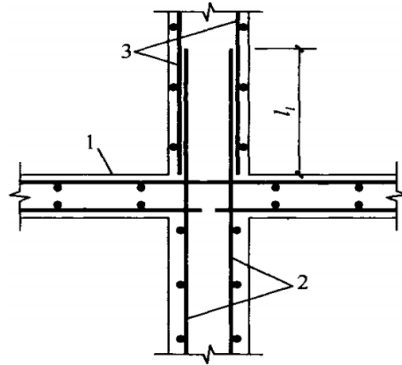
墙体钢筋焊接网的竖向搭接
